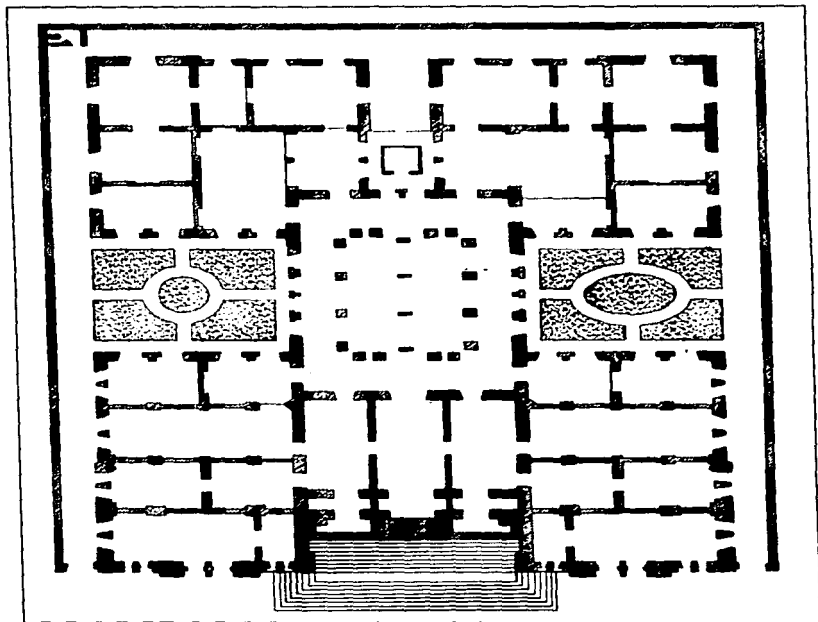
(01) Planta del sótano del Instituto Nacional de Geología.
